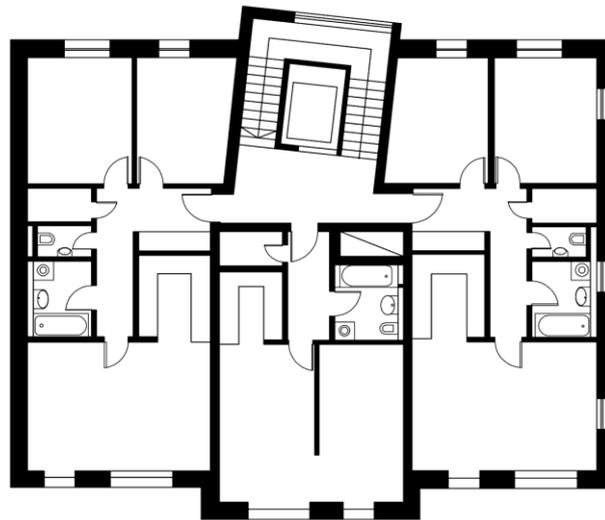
Grundrissplan [Arch. DI Franz Kuzmich]
